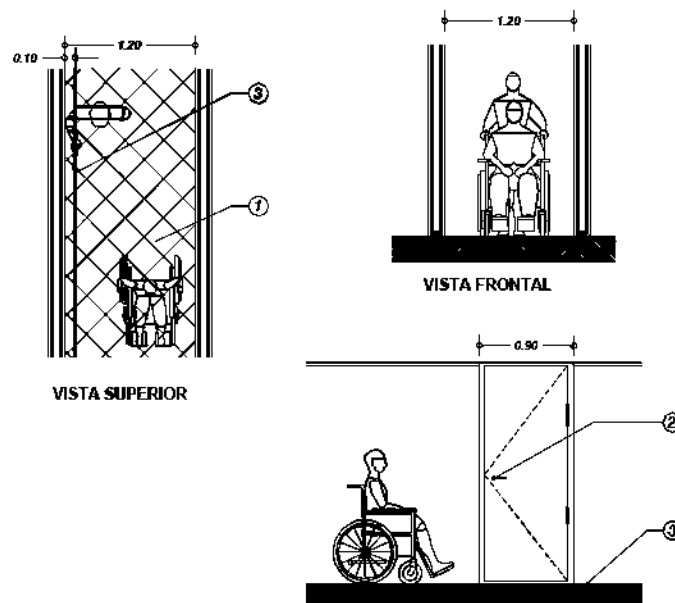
Vista en planta y alzados de las circulaciones. Fuente: manual técnico de accesibilidad a inmuebles federales para las personas con discapacidad. Tomo 1 p. 11.
